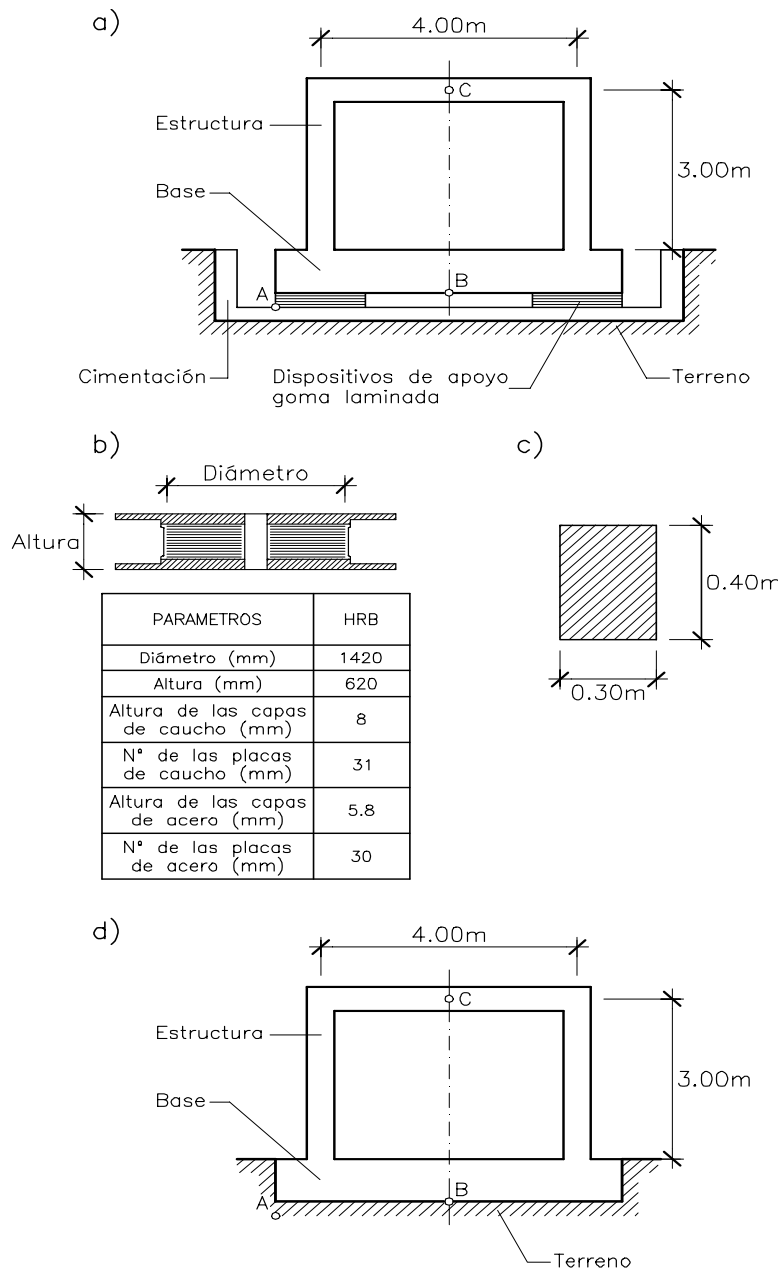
Esquema de la estructura analizada. a) Estructura con aislamiento de base. b) Dispositivo de aislamiento. c) Sección transversal de pilares y dintel. d) Estructura de base fija.
